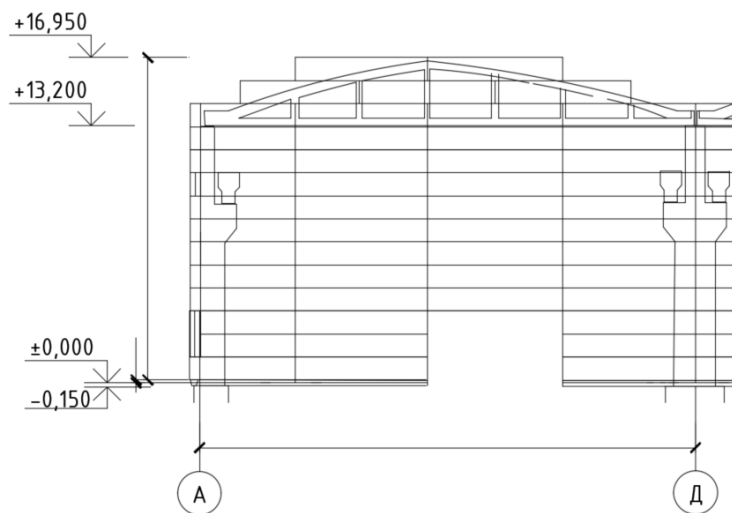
Схема розташування стінових панелей в торці будівлі
